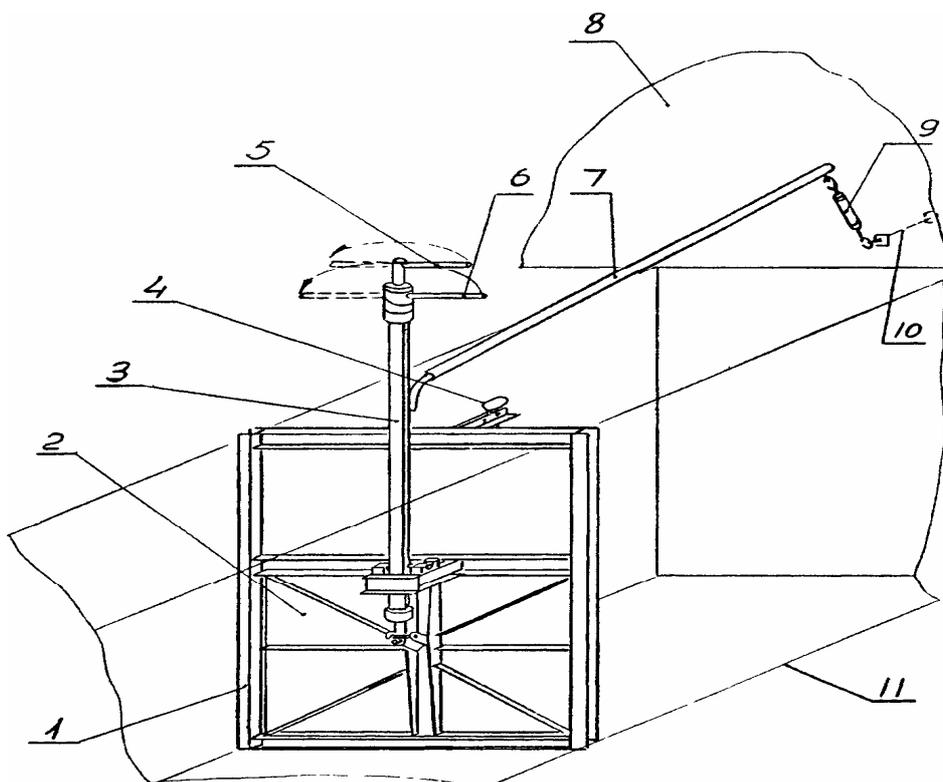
Схема затвора шиберного для продольного навозосборного шин-ф-0,6 канала (положение - канал закрыт шибером)
